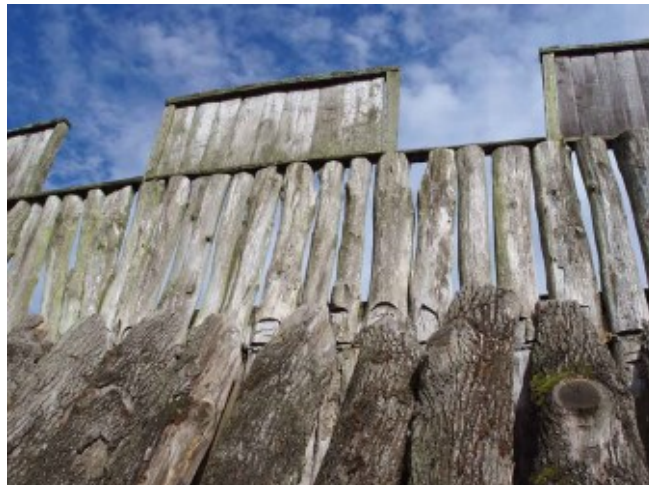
Dettaglio della ricostruzione del paramento esterno in sezioni di tronco d'albero e parapetto ligneo.
